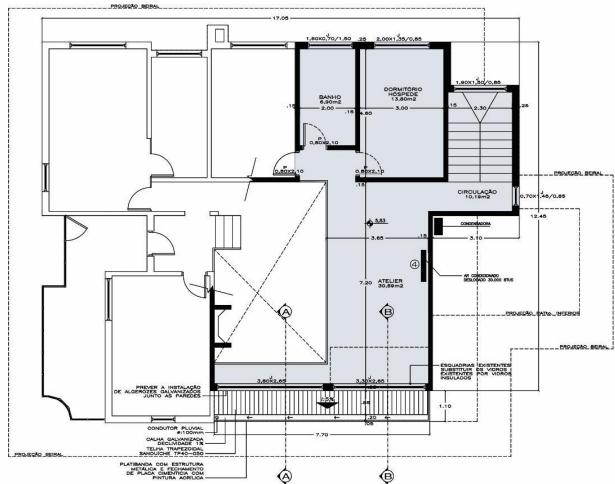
Planta baixa térreo. Fonte: Nr Arquitetos.
